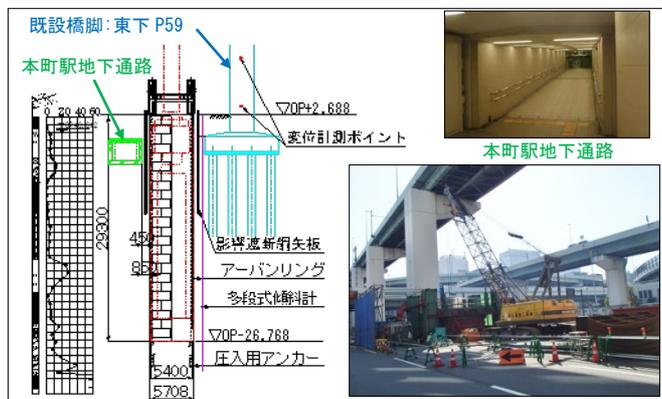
東下 P58R 概要断面図 (左) 施工状況写真 (右)
